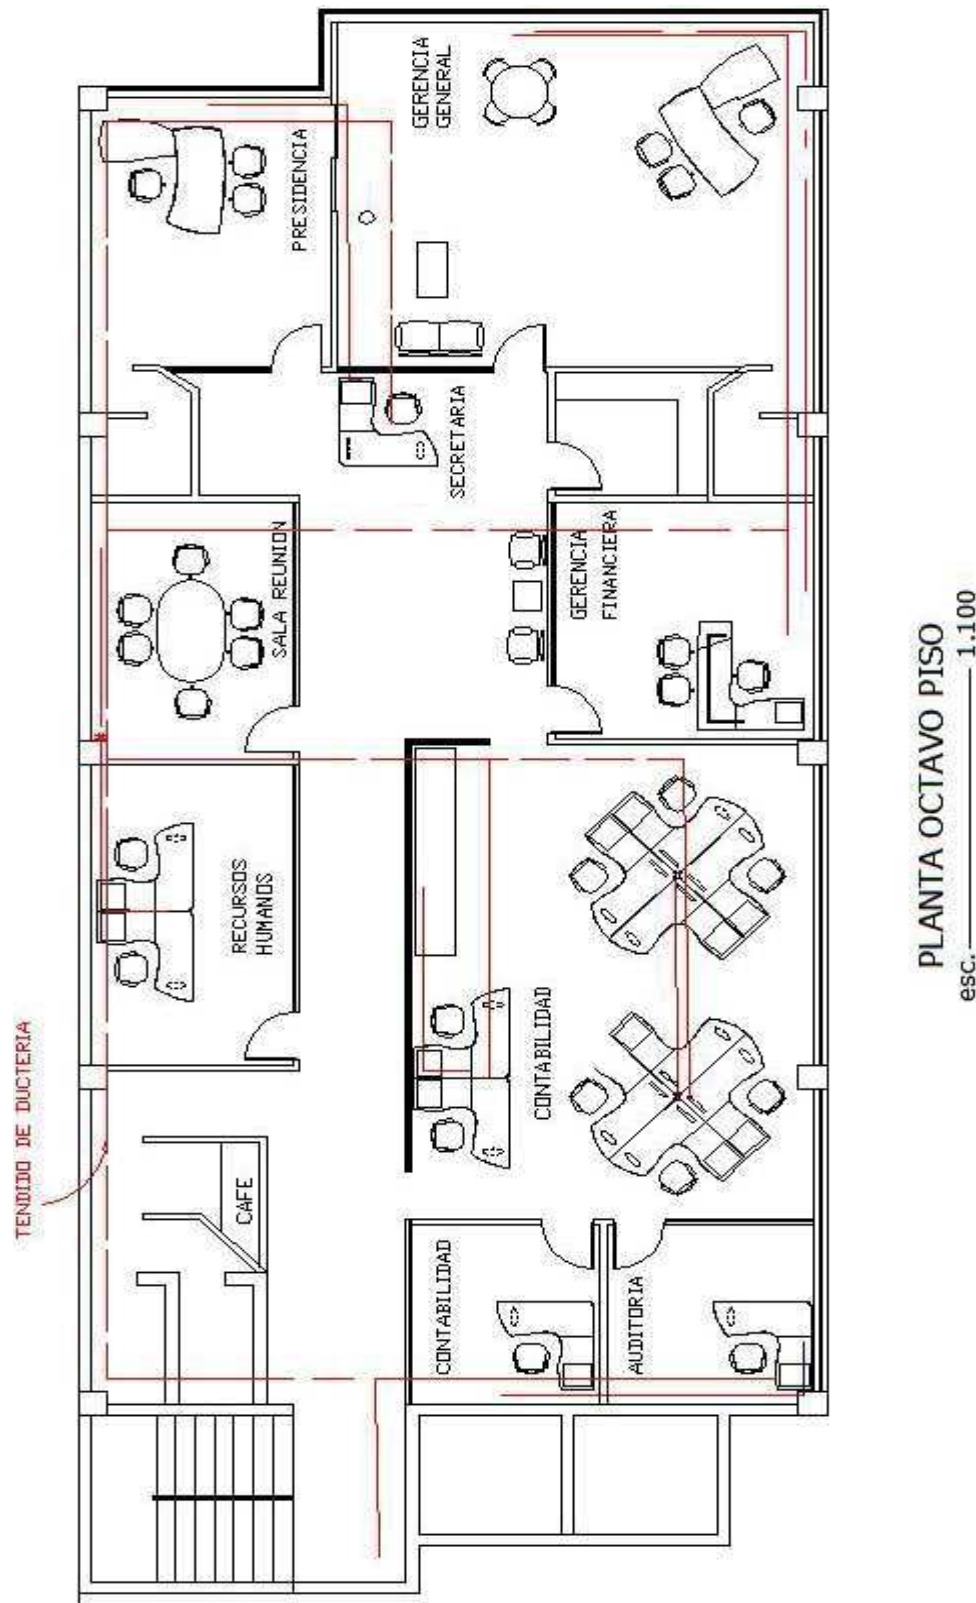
Distribución ductería propuesta Octavo Piso.
